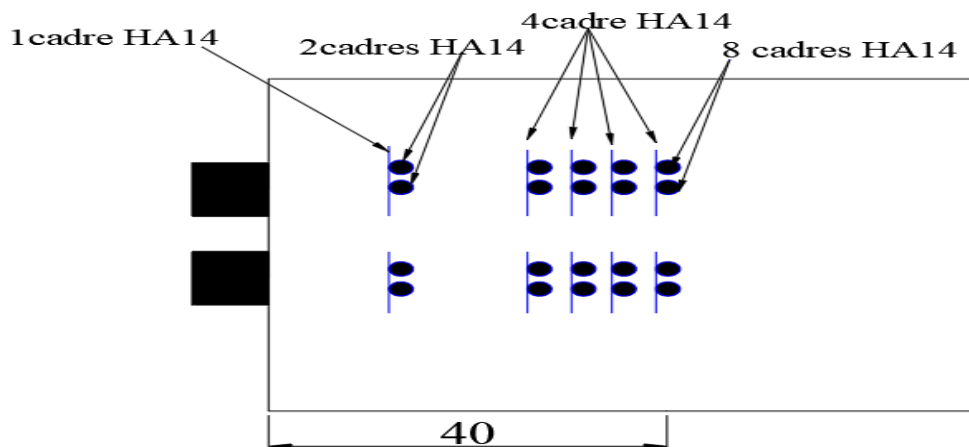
Ferrailage de la zone d'ancrage de l'about
